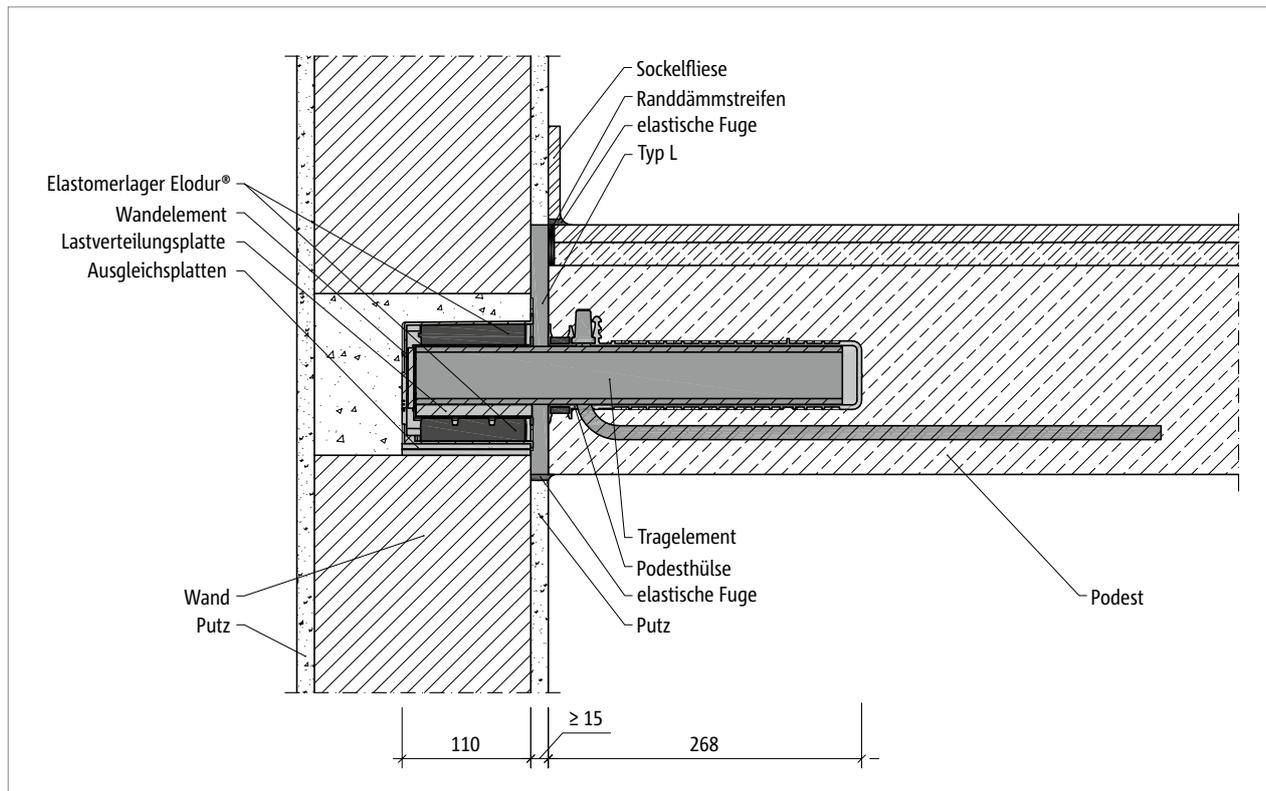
Schöck Tronsole® Typ P: mit Ortbetonpodest und Tronsole® Typ L
